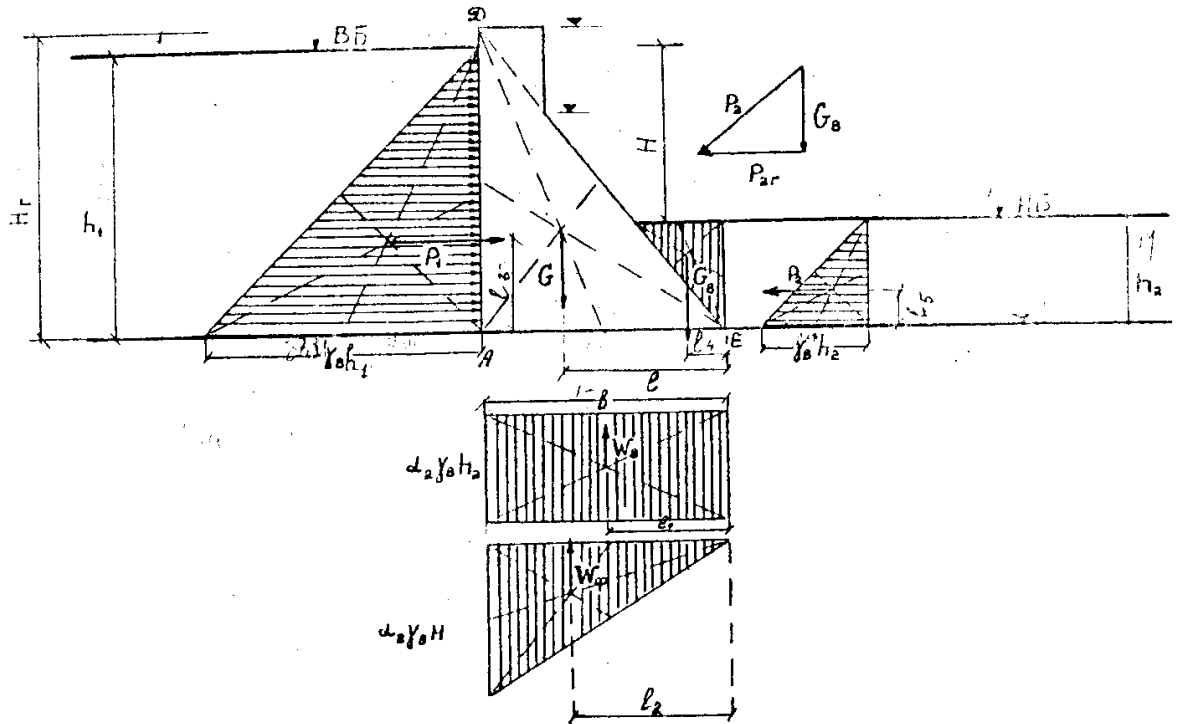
Розрахункова схема діючих на бетонну греблю сил
